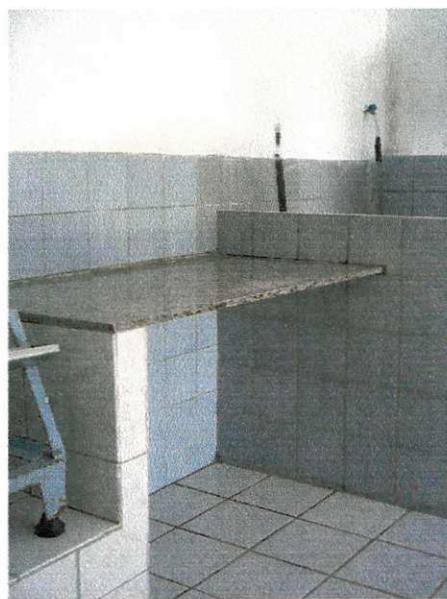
b- Área de lavagem das garrafas, engarrafamento e rotulagem, do Engenho Vaca Brava de Baixo
